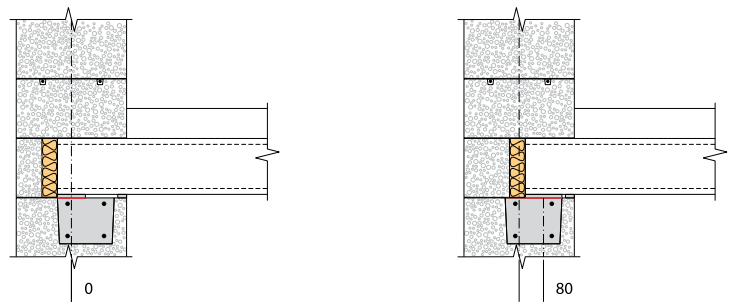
Варианты перекрытий по стенам из блоков ЛСР
